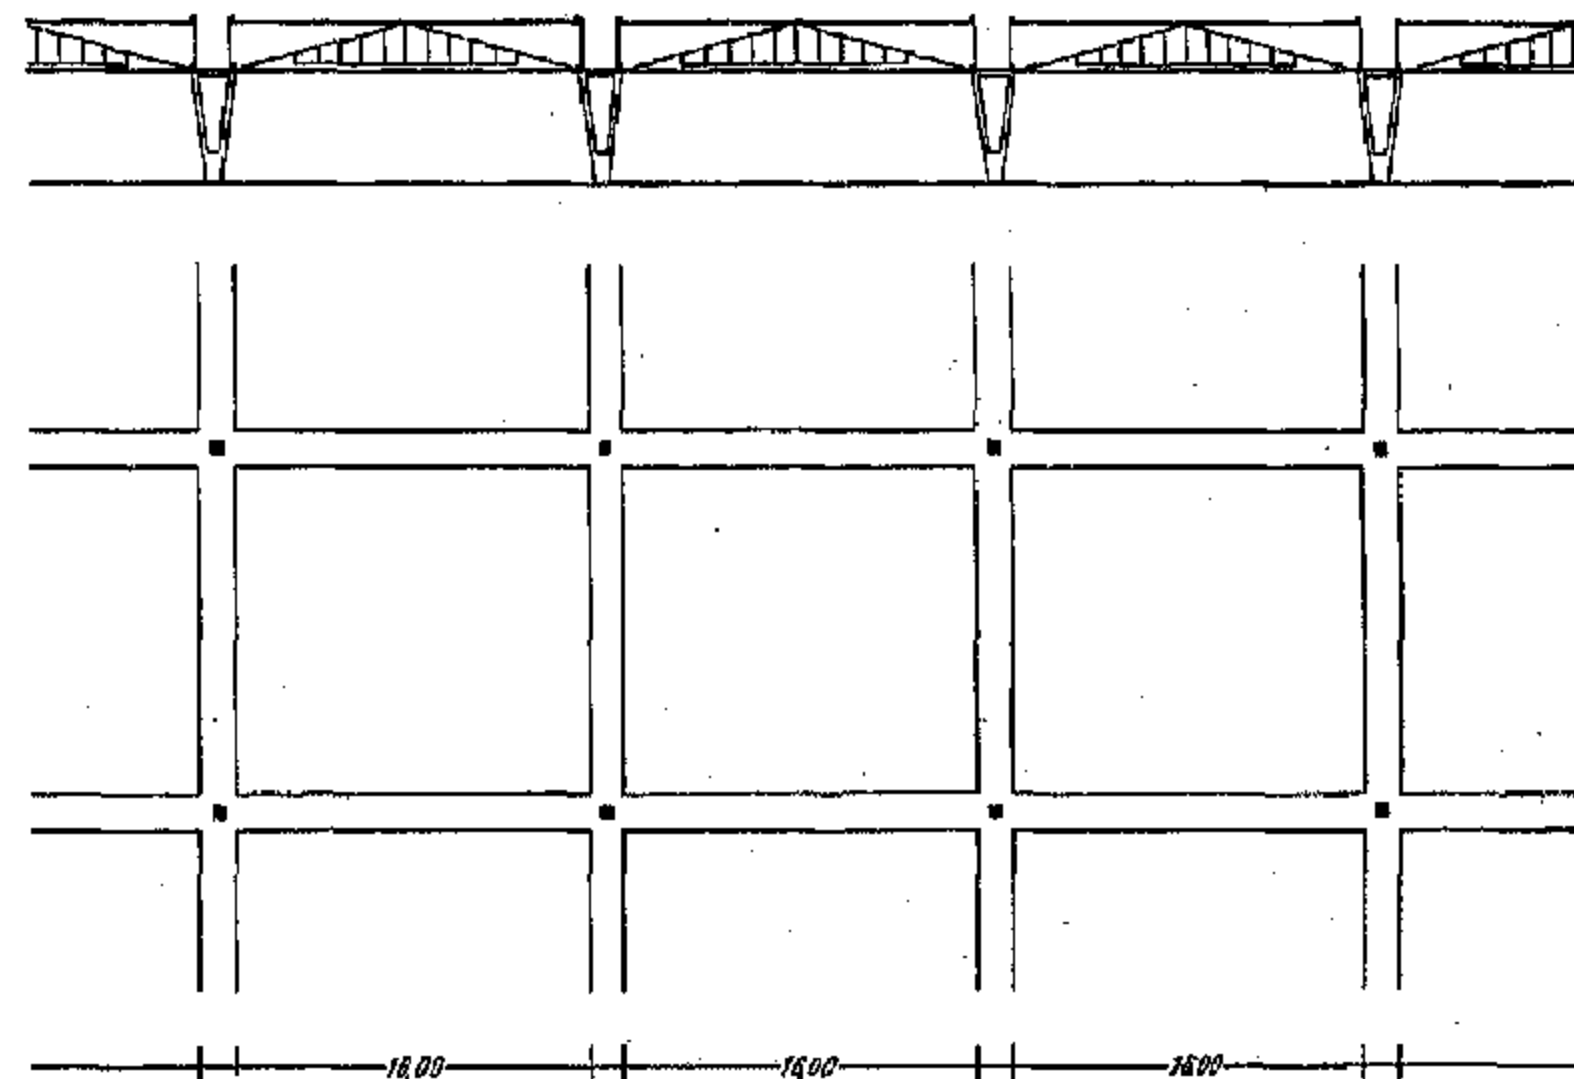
مسقط للباقيات وقطاع.
